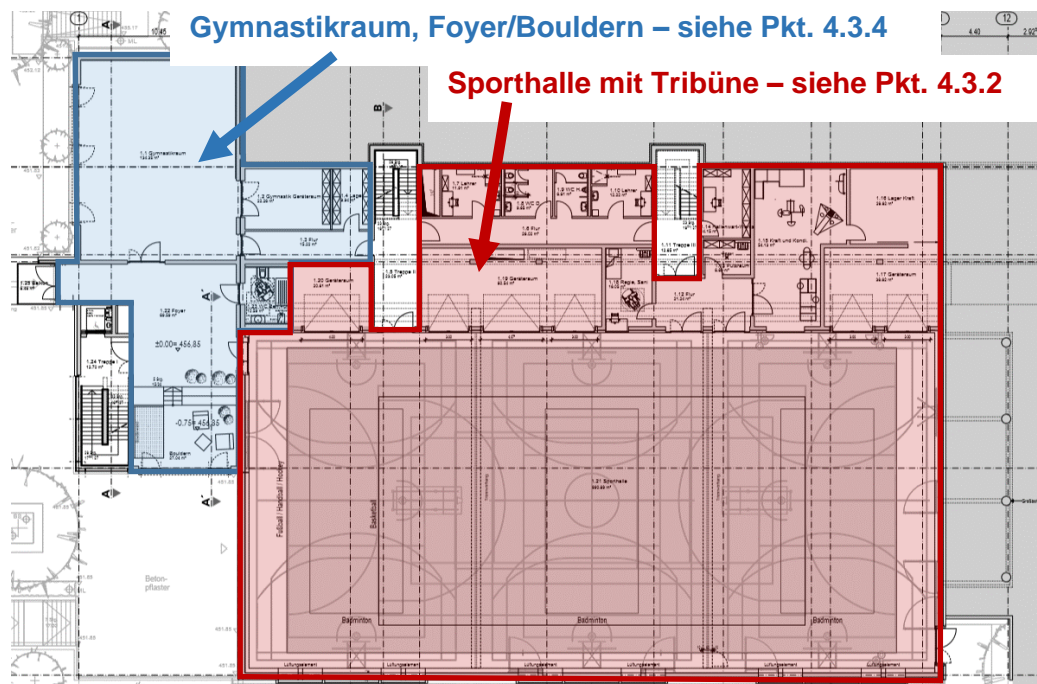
Grundriss Geschossebene 1/EG – Übersicht Nutzungsbereiche
